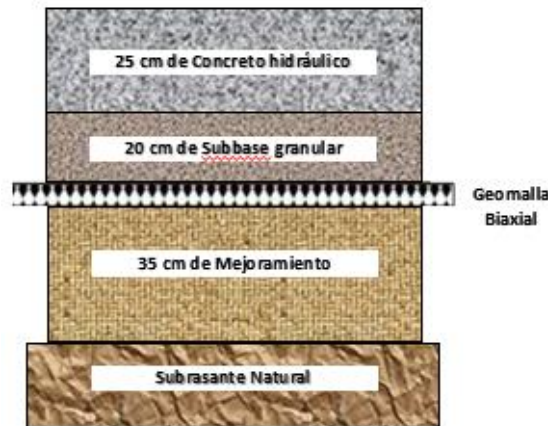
Diseño Pavimento rígido primer sector – intersección con la variante de Popayán y la abscisa K1+000.
